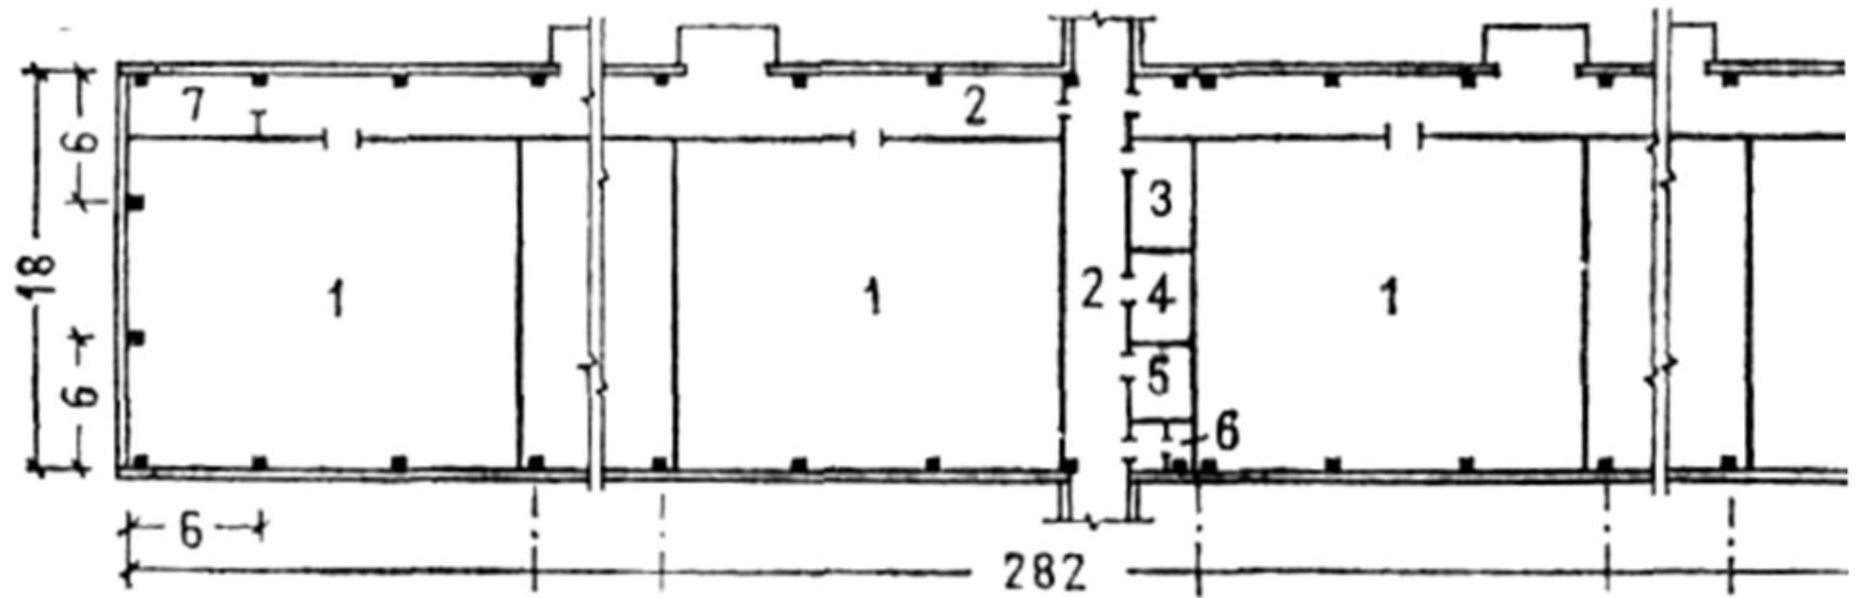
План хранилища лука на 1 200 тонн
